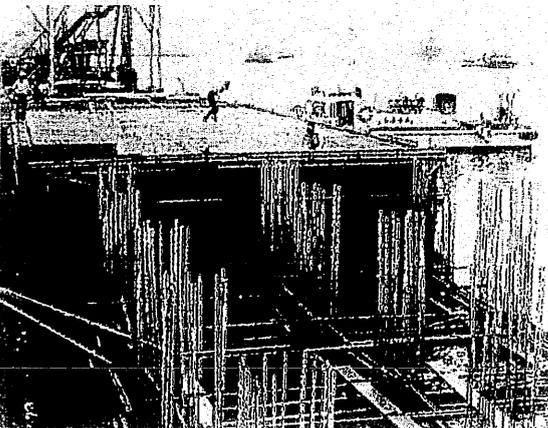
Feuerverzinkter Betonstahl an einer Hafenanlage in Japan
